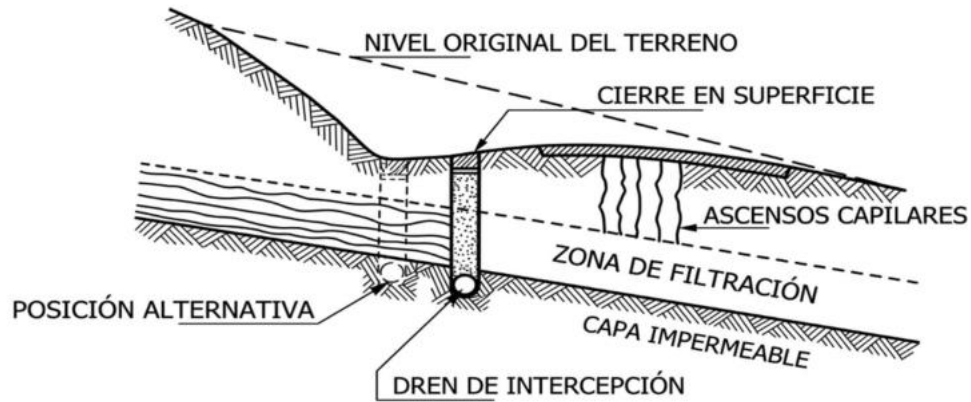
Drenaje subterráneo. Nota. Tomado de Manual para el diseño de carreteras pavimentadas (2008, p.78).
